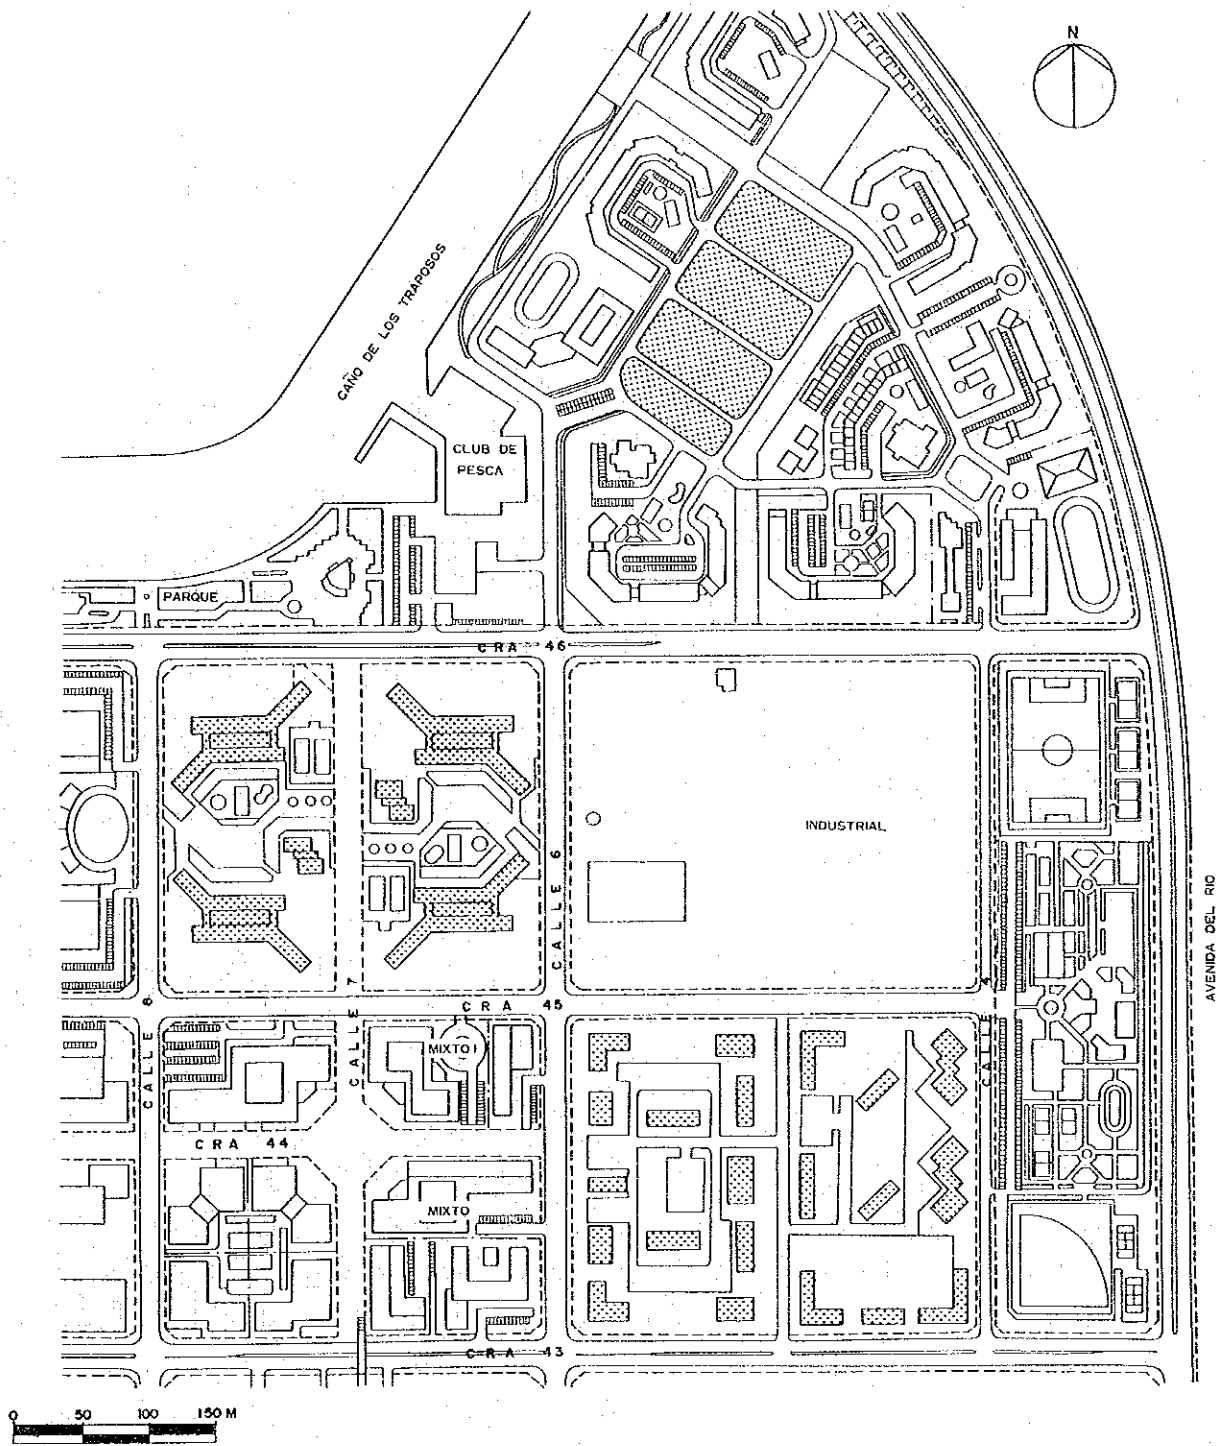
PLANO DE LA ZONA RESIDENCIAL
